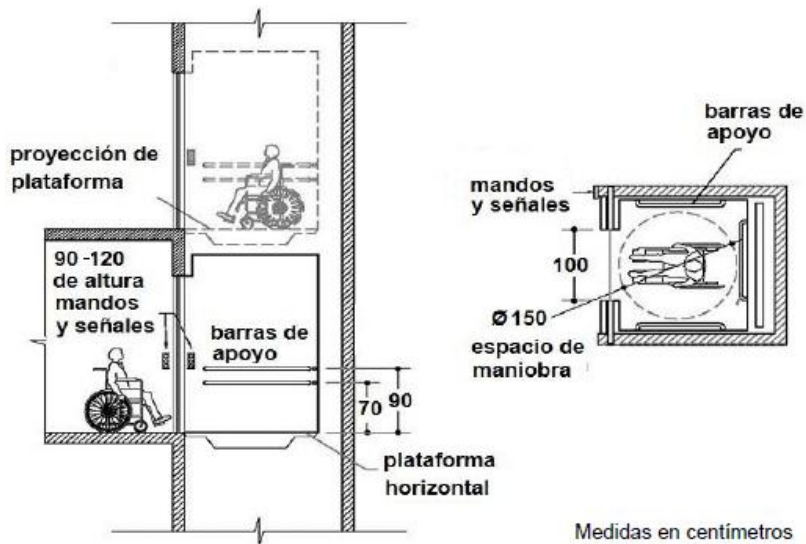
VISTA EN SECCIÓN Y PLANTA DE UN ELEVADOR, ASCENSOR O PLATAFORMA.
